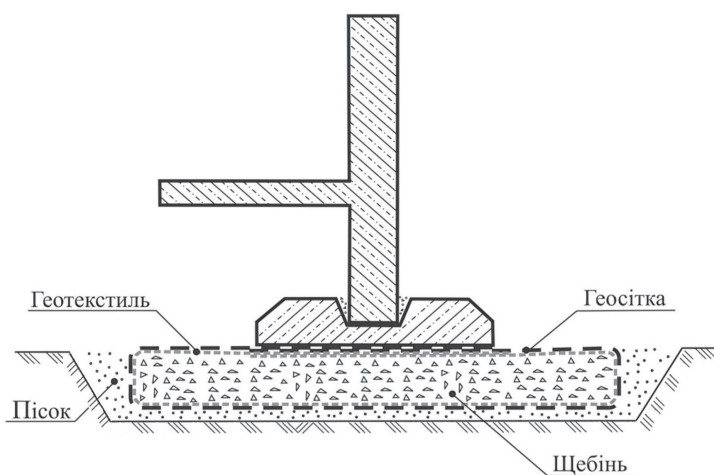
Конструкція стовпчастого фундаменту з геормованою фундаментною подушкою
